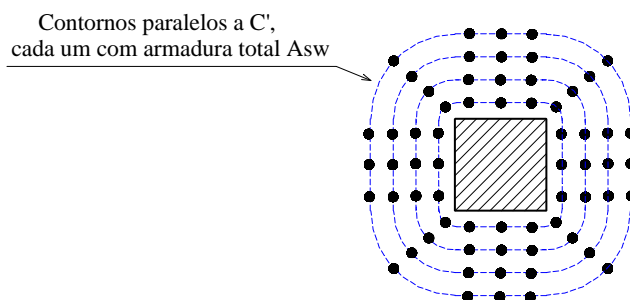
Disposição da armadura A_{sw} para pilares internos
